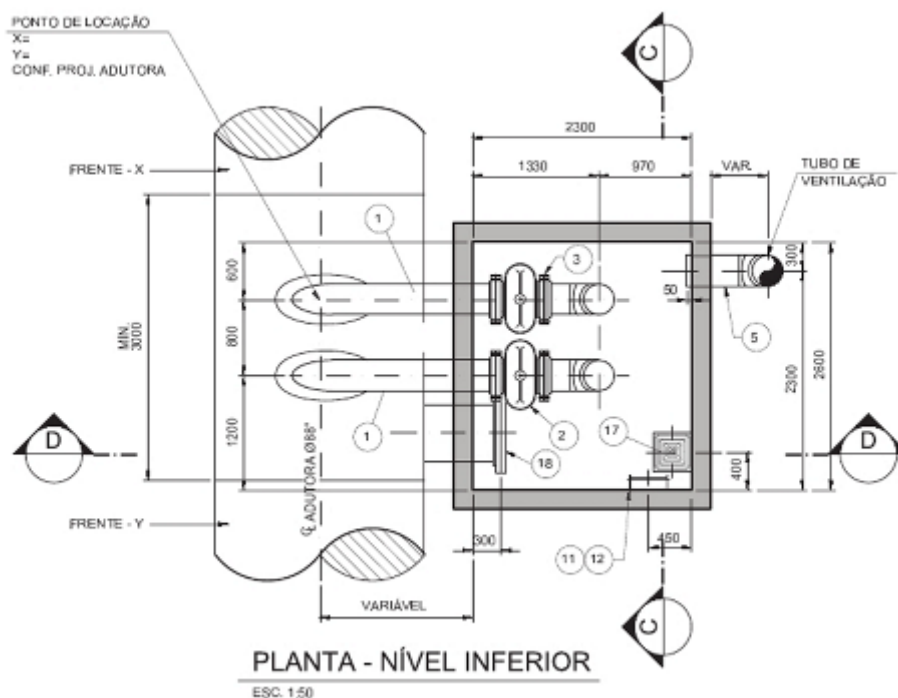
Planta do esquema das Válvulas Quebra-Vácuo
